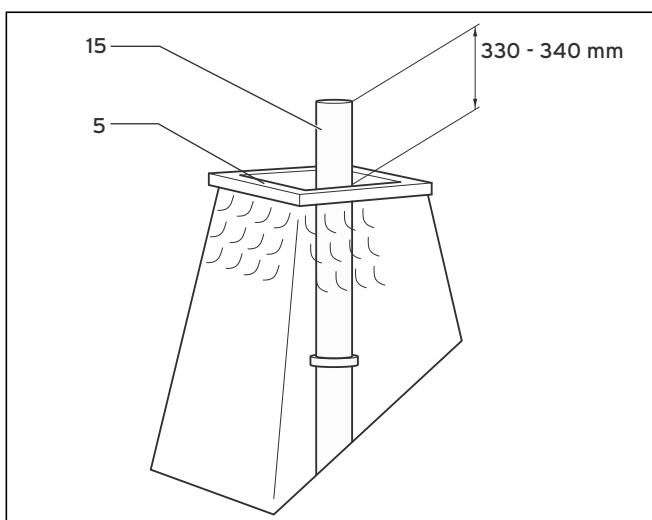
Укорачивание трубы из нержавеющей стали
